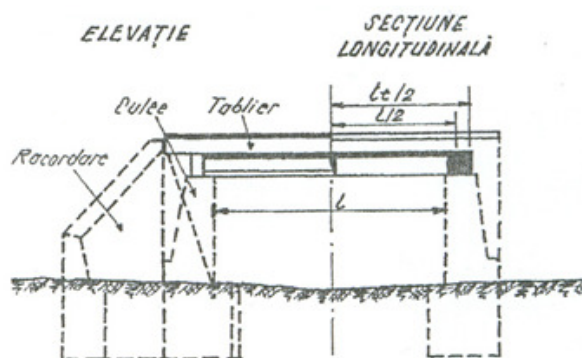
Elemente constructive ale podețelor dalate din beton armat
